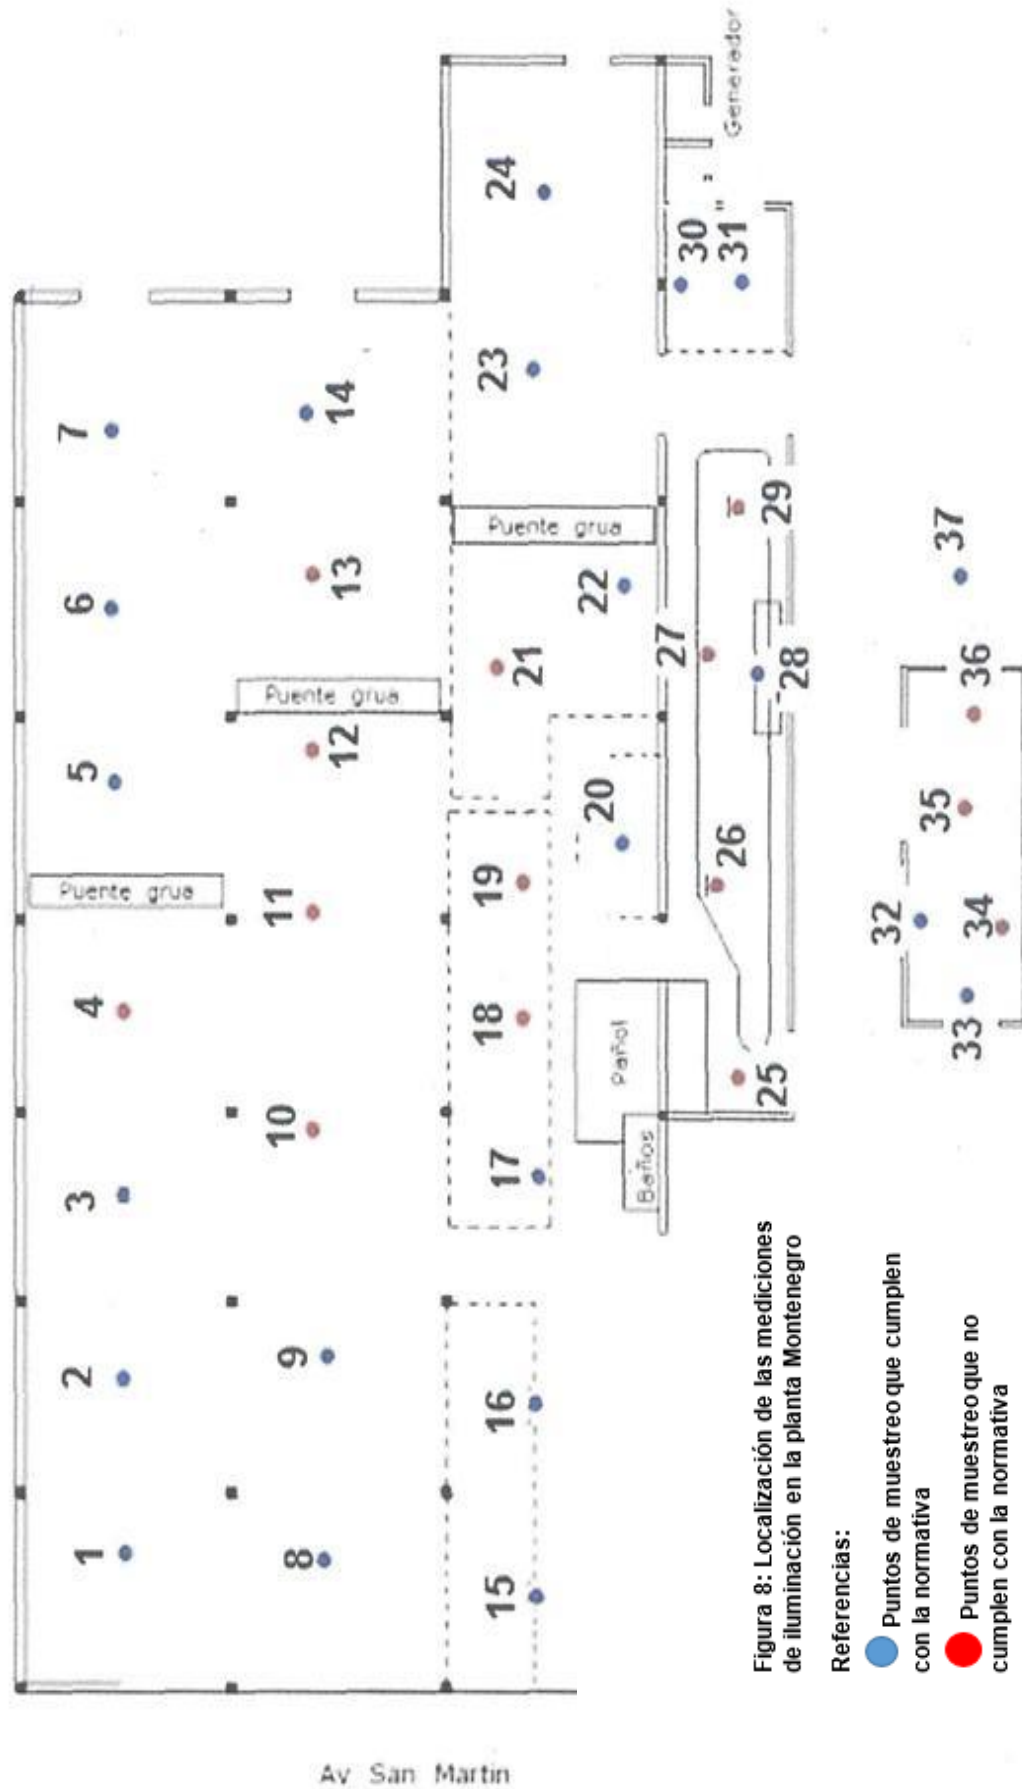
Localización de las mediciones de iluminación en la planta Montenegro
